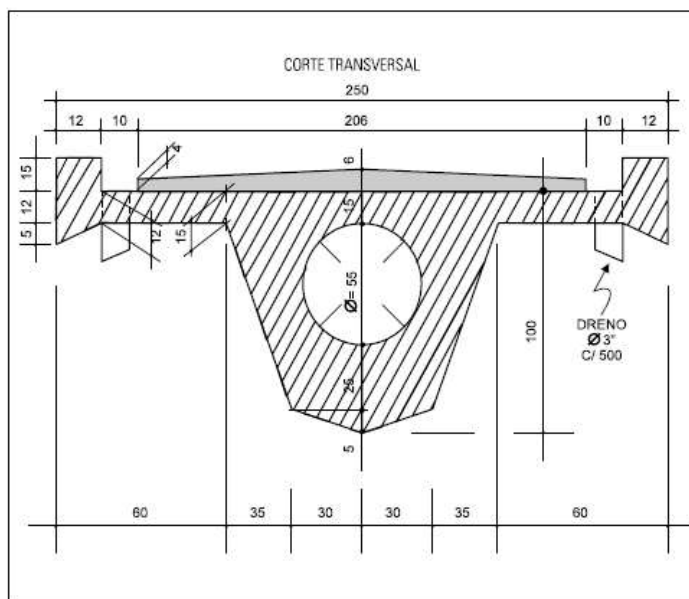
SEÇÃO TRANSVERSAL E DETALHES
